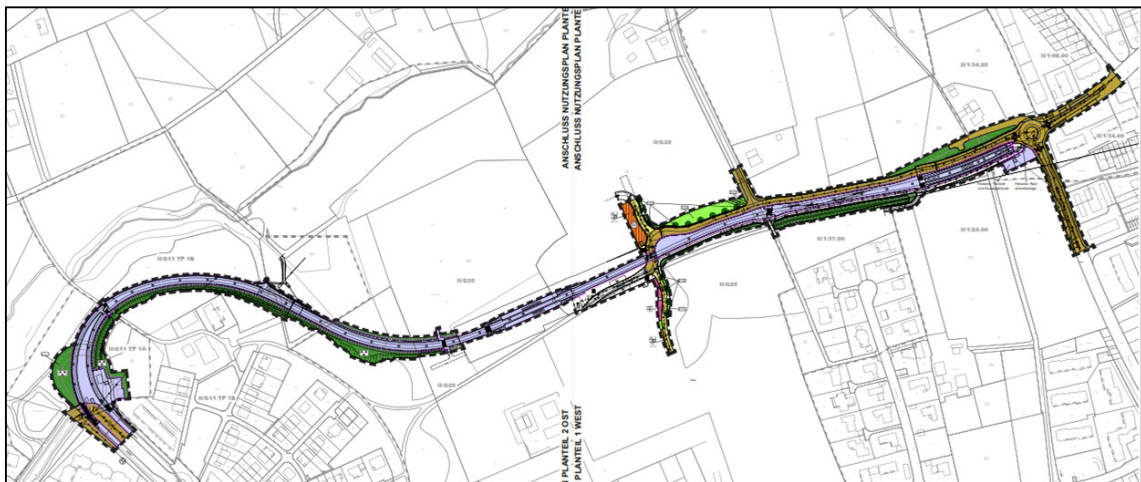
Entwurf des Bebauungsplans II/G 21 „Stadtbahn zu Campus Nord“ (Claussen-Seggelke, 2016)
